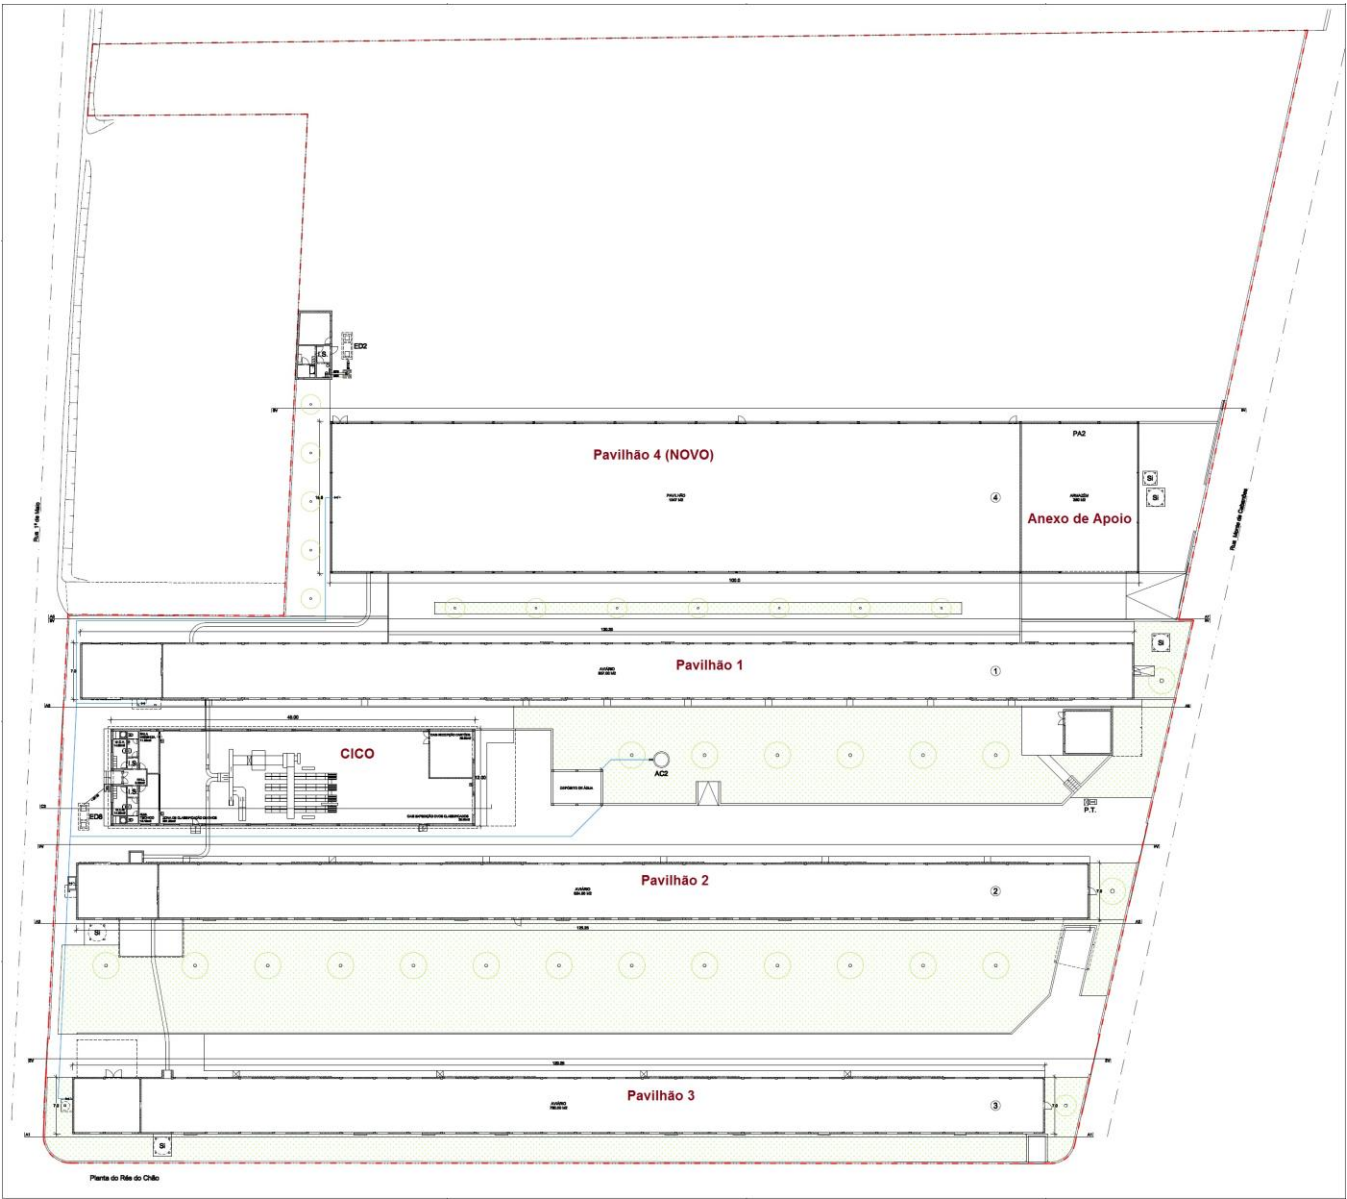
Planta esquemática do NP2: principais elementos edificados de produção e apoio (sem escala).
